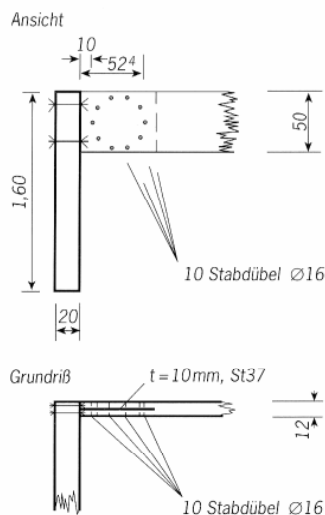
Anschluß Hauptträger – Aussteifungsträger, Detail zu Bild 4
